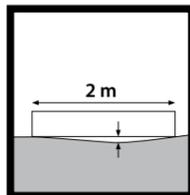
La planitud se verifica con una barra de al menos 2 m, apoyándola sobre el fondo en todas las direcciones. La tolerancia admitida es de 2 mm.
